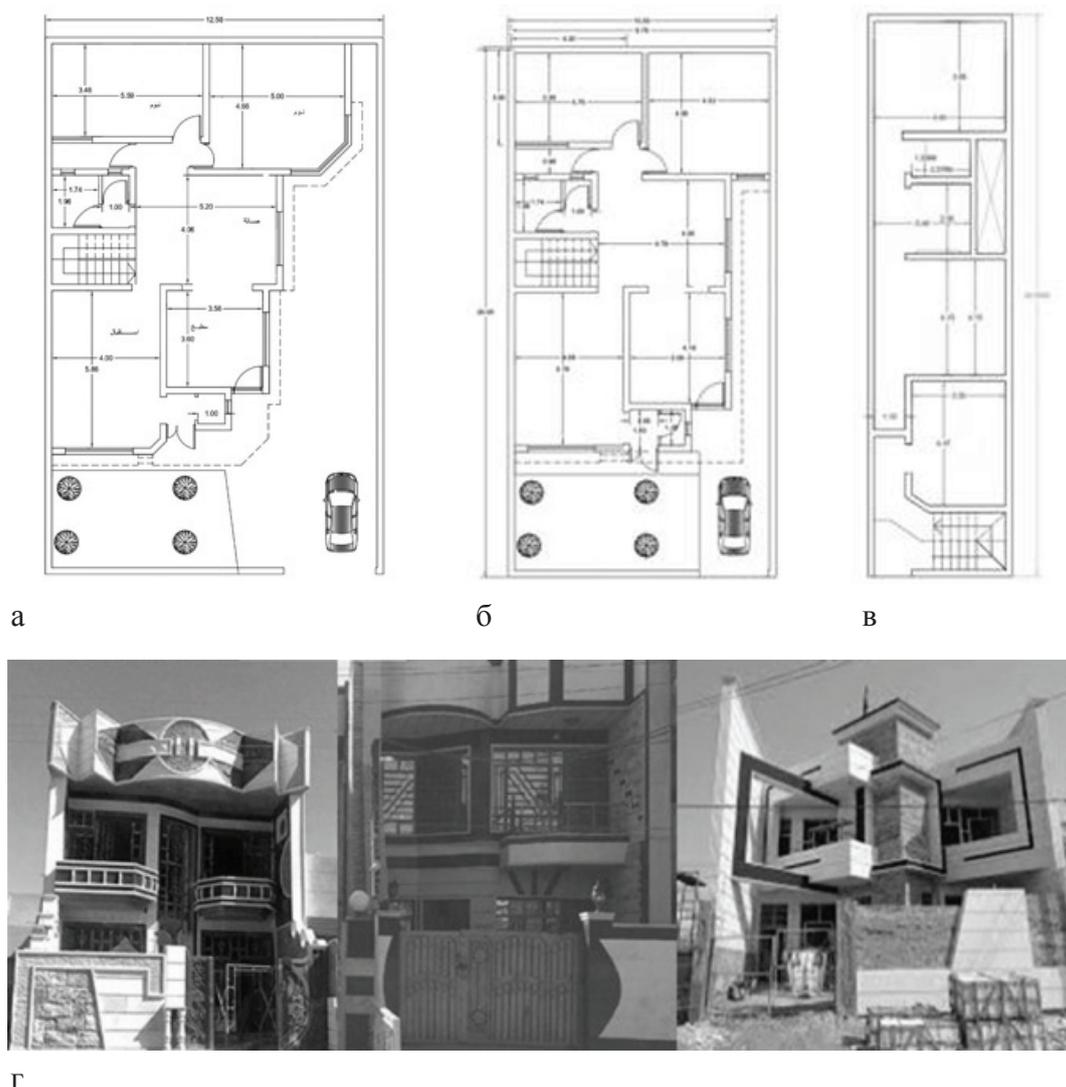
Паттерны форм жилья в районе Б: а) план дома 250 м²; б) план дома 200 м²; в) план дома 100 м²; г) общий вид домов. Источник: а,б,в) Муниципалитет провинции Наджаф; г) Фото Аль-Шайбани Алаа Абд Али
